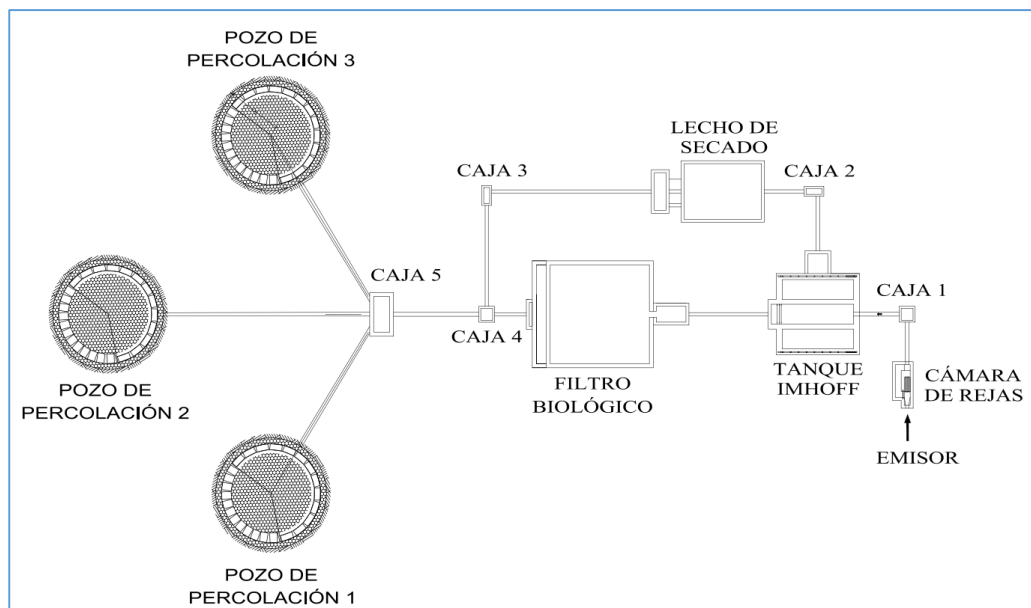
Planta general de la planta de tratamiento de aguas residuales
